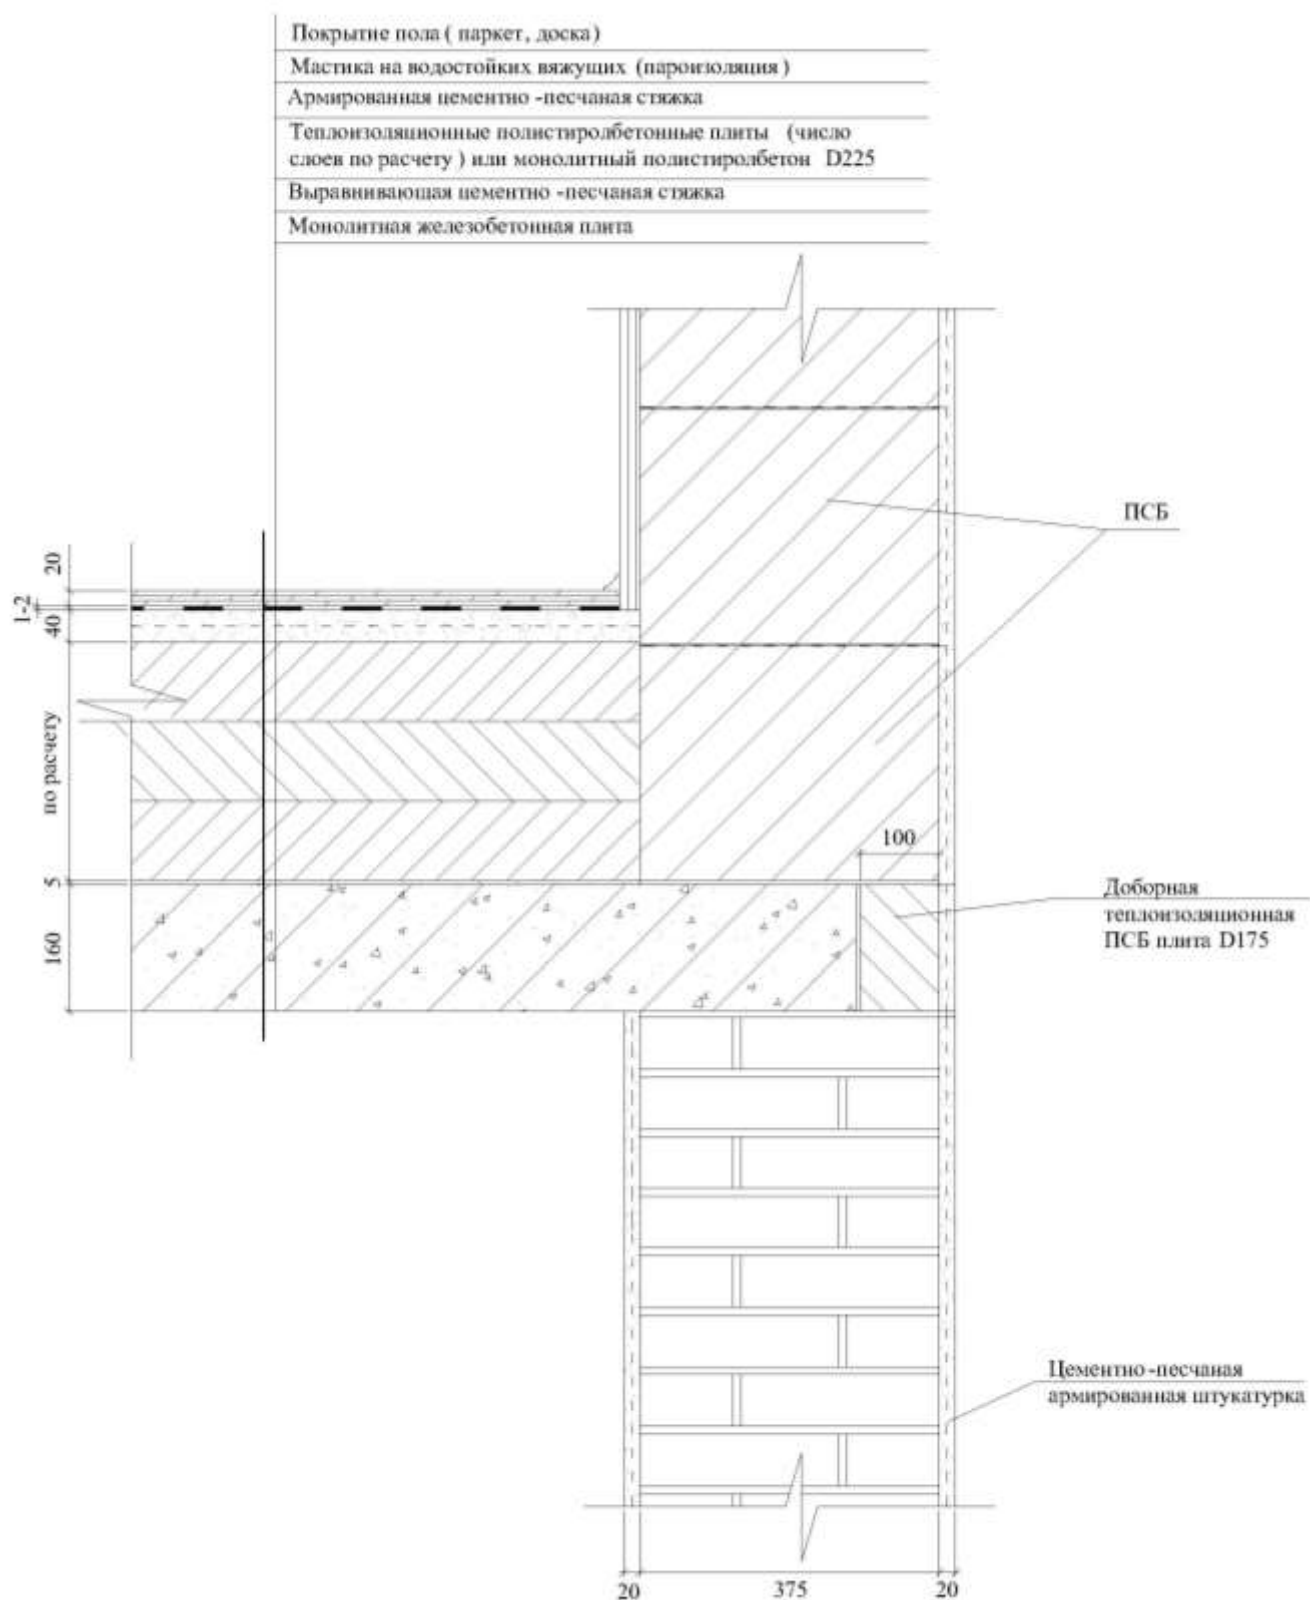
Утепление перекрытия над холодными подвалами (подпольями, проездами) с использованием теплоизоляционных плит или монолитного полистиролбетона
